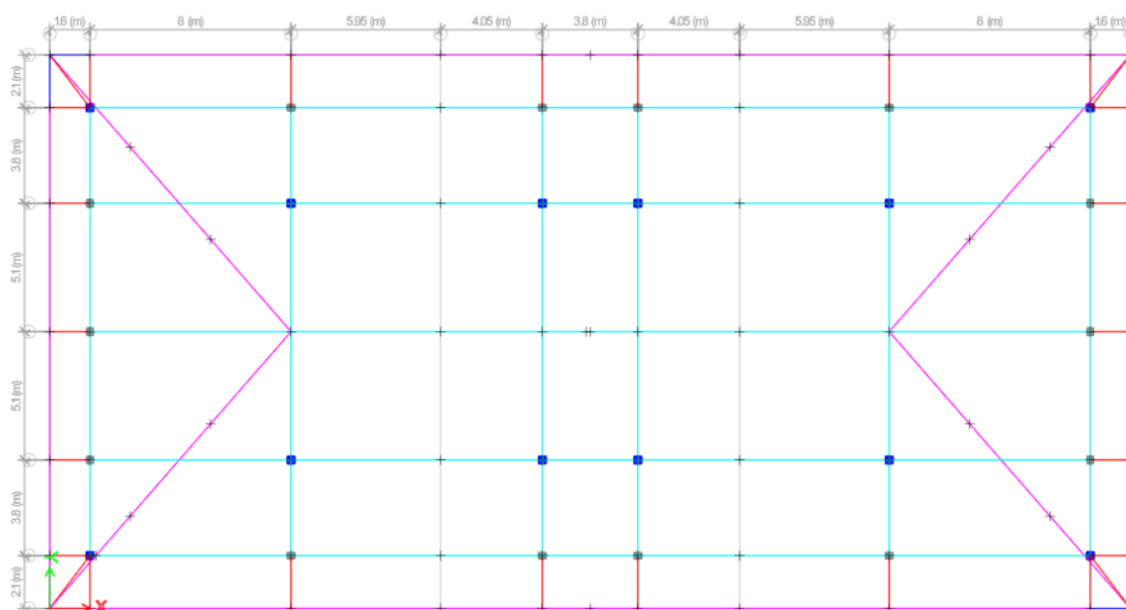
Vista en planta del piso alto de la edificación.
